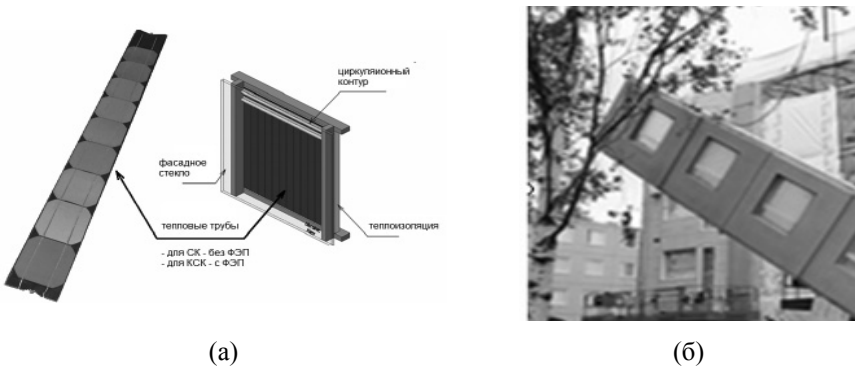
Возможное применение панелей для утепления фасадов зданий на основе СК и КСК с алюминиевыми тепловыми трубами: а – схема, б – пример обычного модульного утепления⁷⁵.
